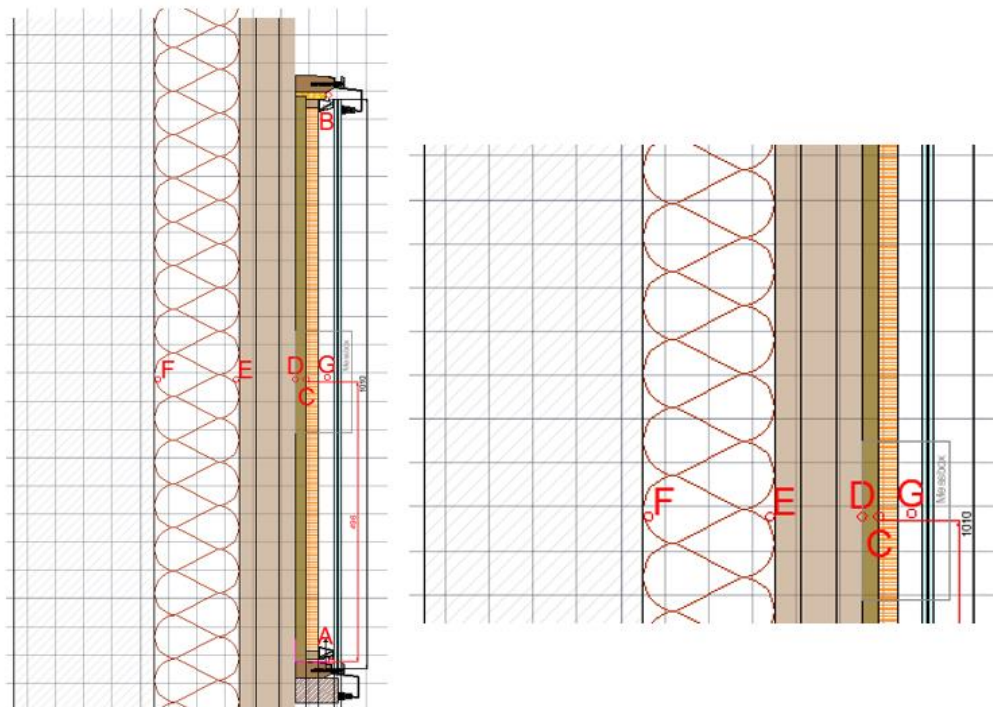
Aufbau Testfassade (Schichtaufbau Fassade)
